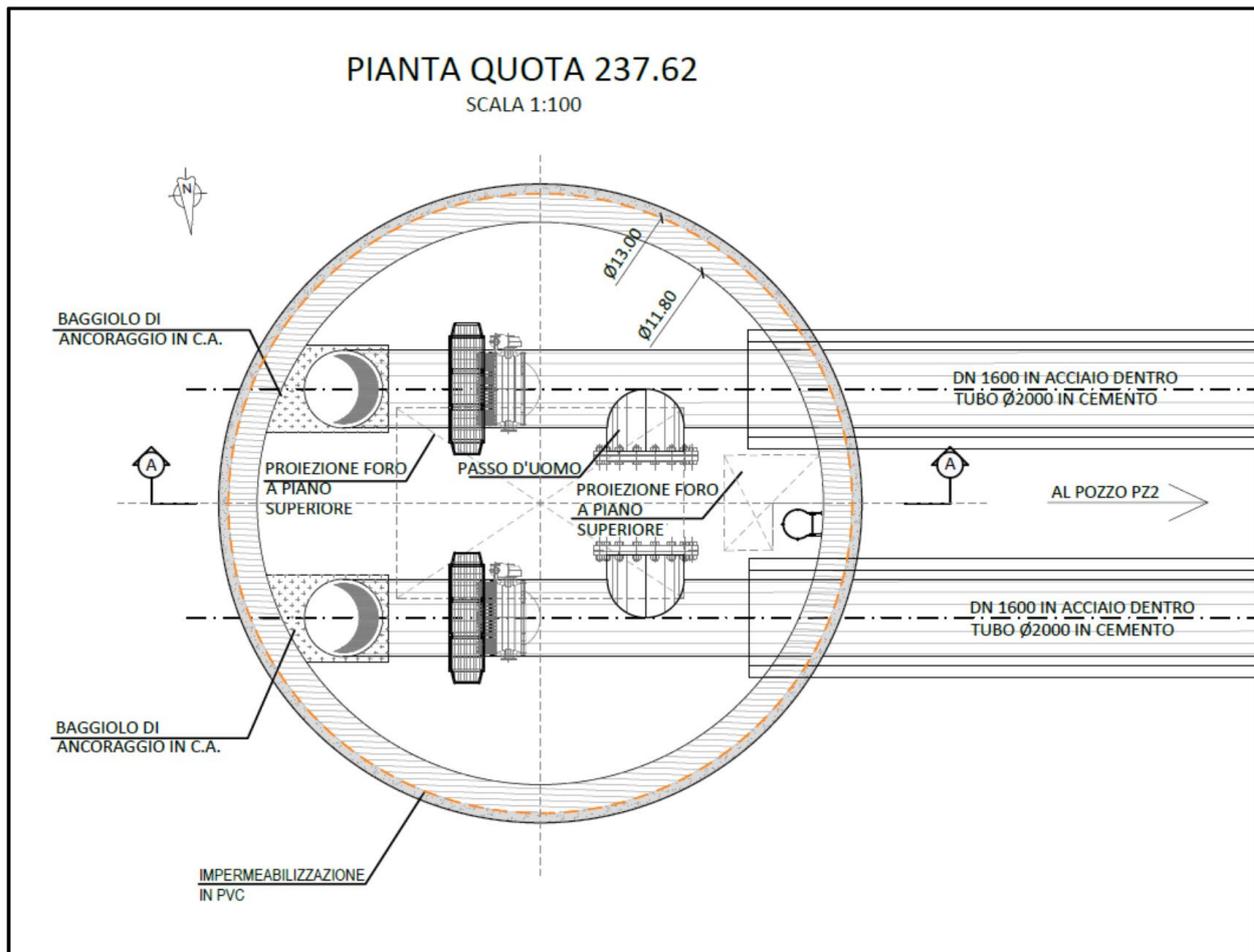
Rappresentazione in pianta del manufatto PZ1
